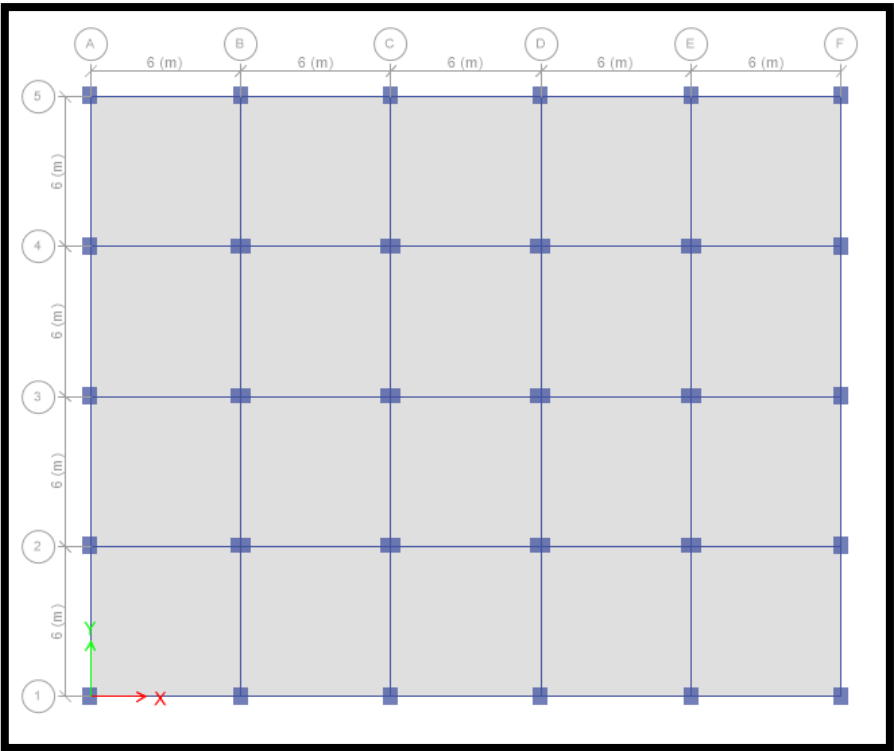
Vista en planta inicial de la edificación y vista de luces entre elementos.
